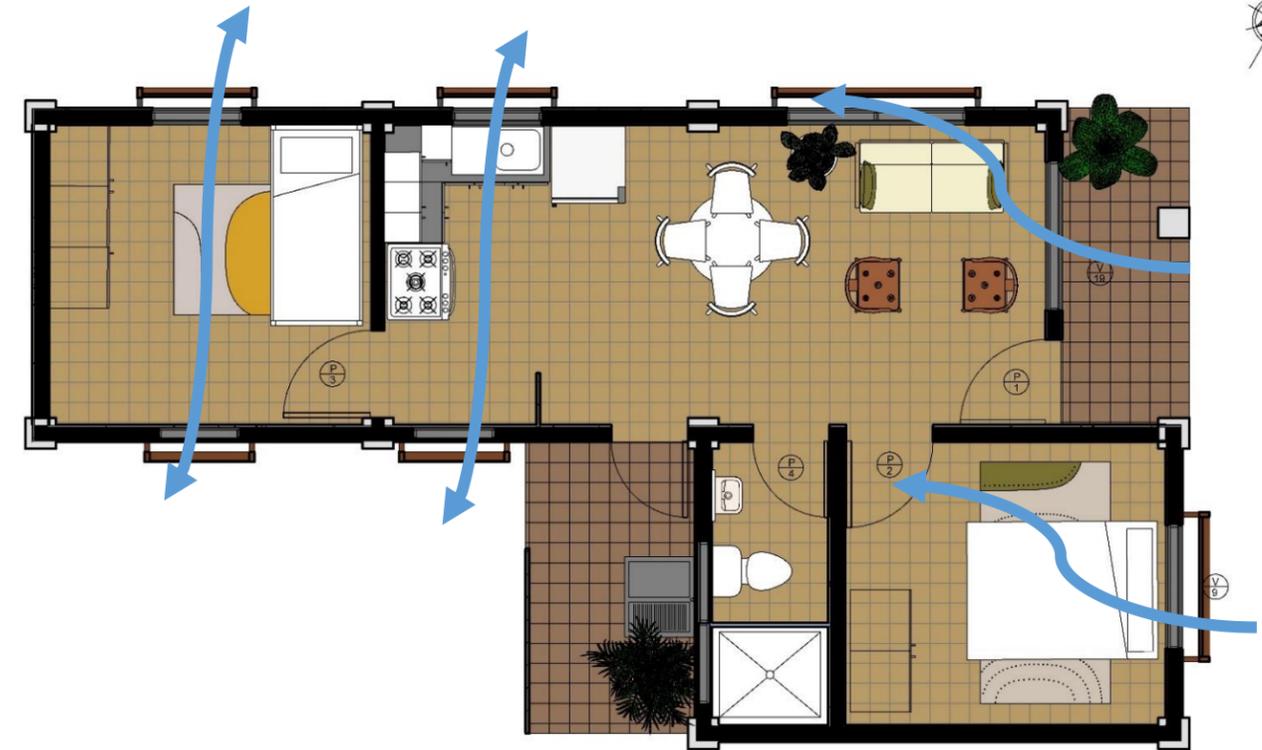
Ventilación natural en planta vivienda modelo H-4. Elaborado por autoras.
